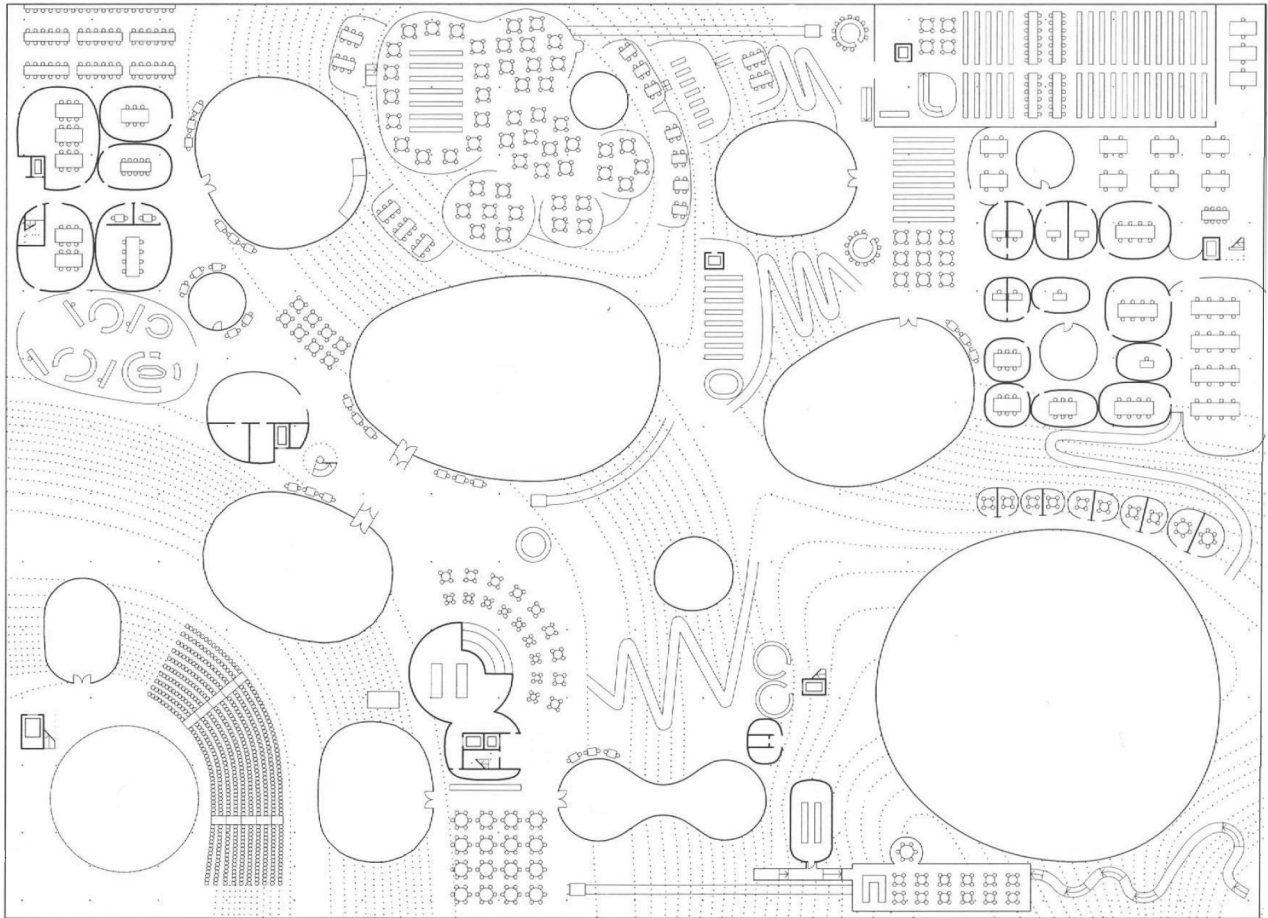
Rolex Learning Center Grundriss M 1:1000
